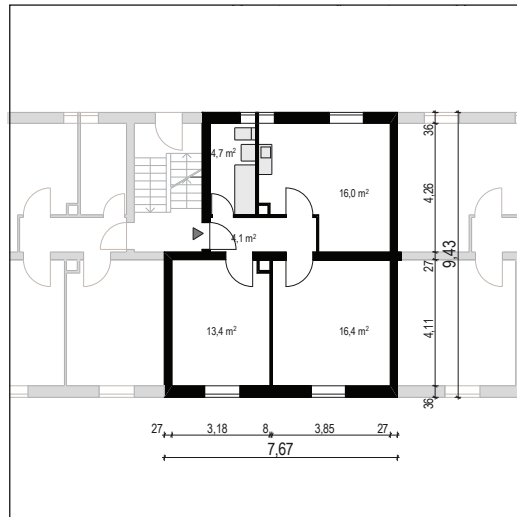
Beispielgrundriss Dachau, Birkenrieder Straße 2
